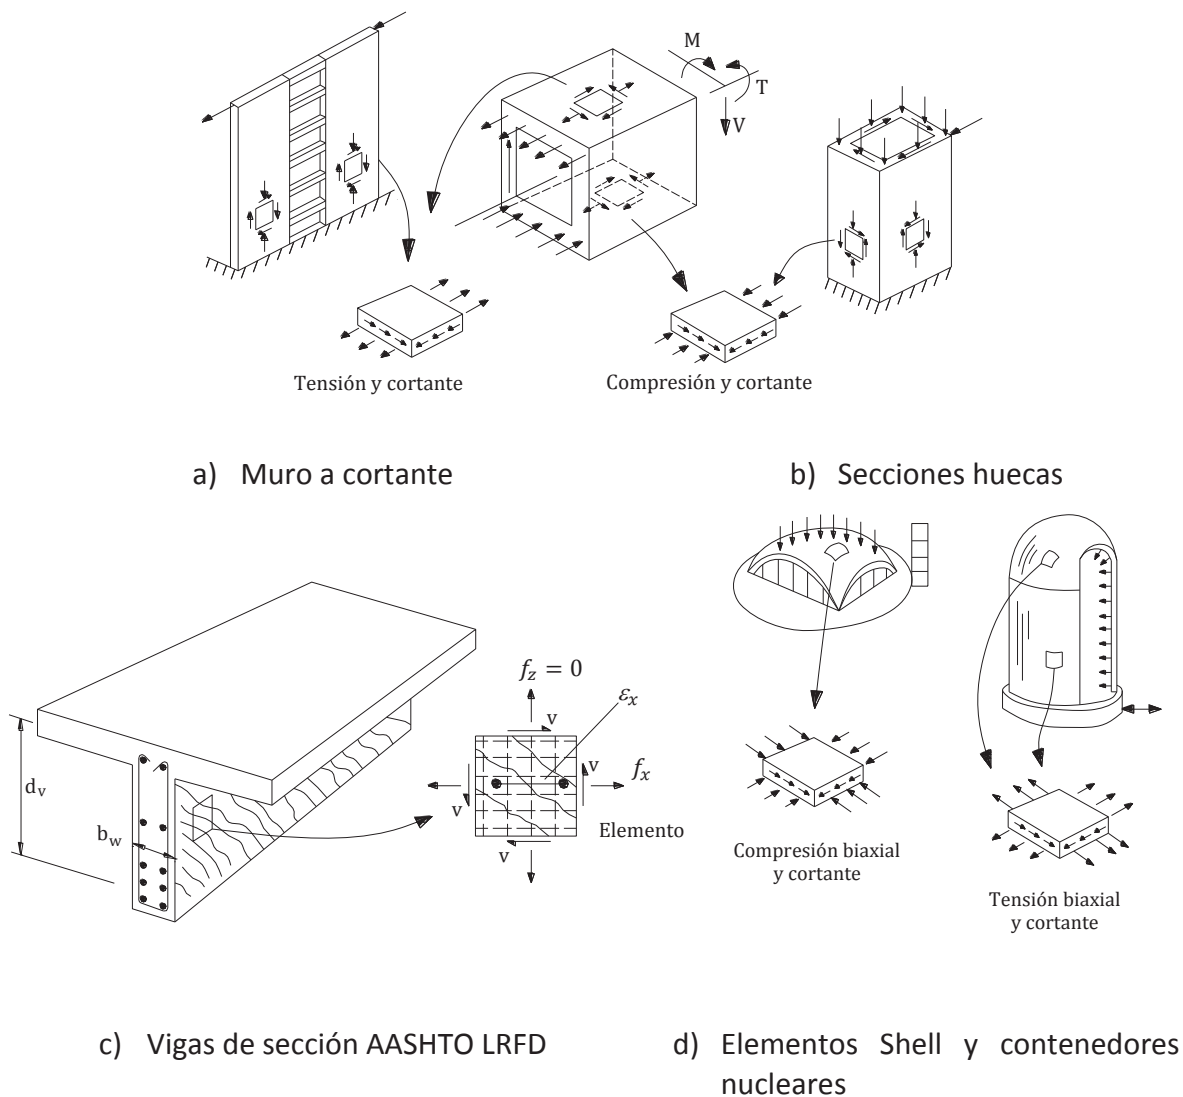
Elementos tipo panel de estructuras de concreto
